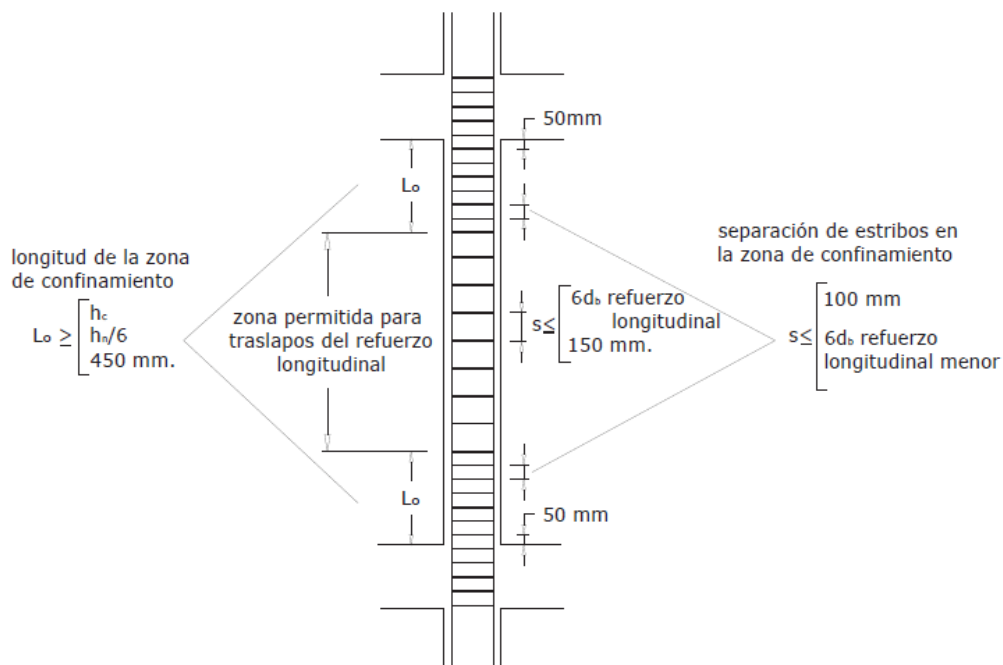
Esquema de refuerzo longitudinal y transversal en columna.
